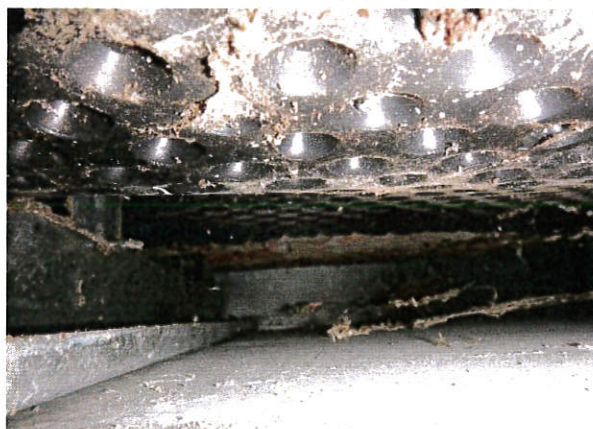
16 – pohledy a detaily krovu, odvětrání kanalizace
